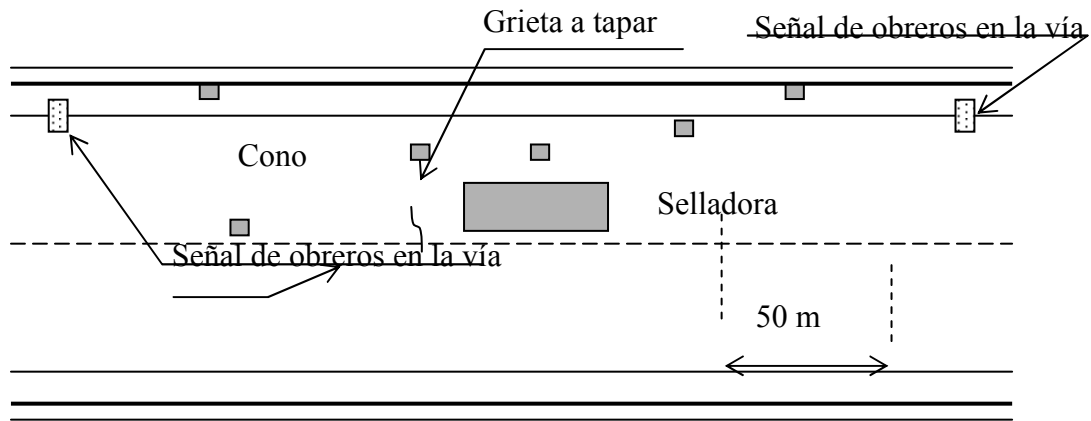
Señalización para el sellado de grietas en el pavimento. (Elaborado por los autores).
